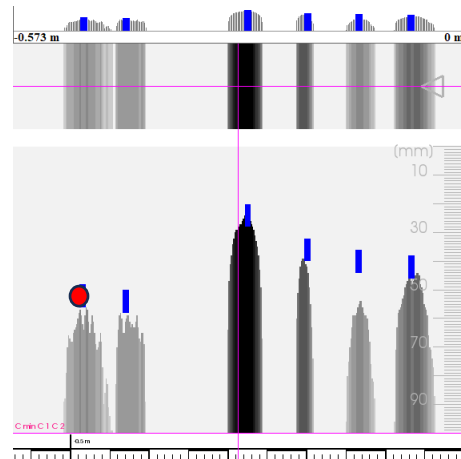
Poutre Pt02 – Travée 3 côté P2
